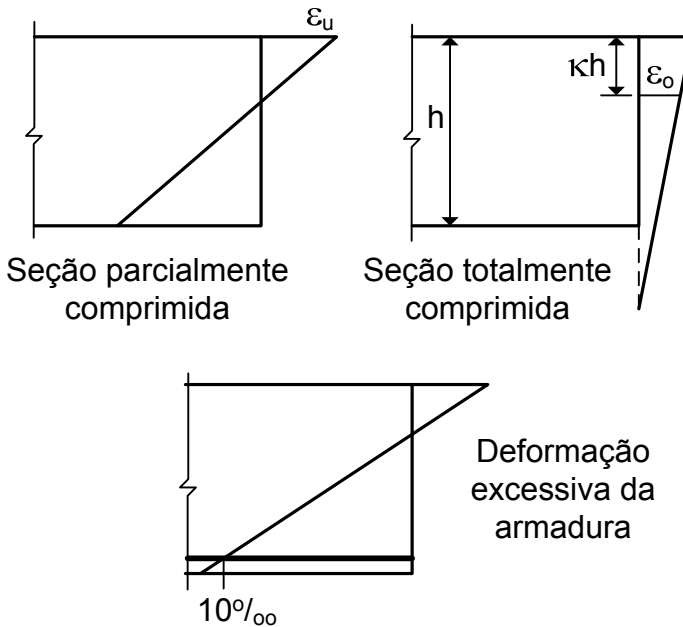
Situações de ruptura de uma seção de concreto armado (flexão simples ou composta)
